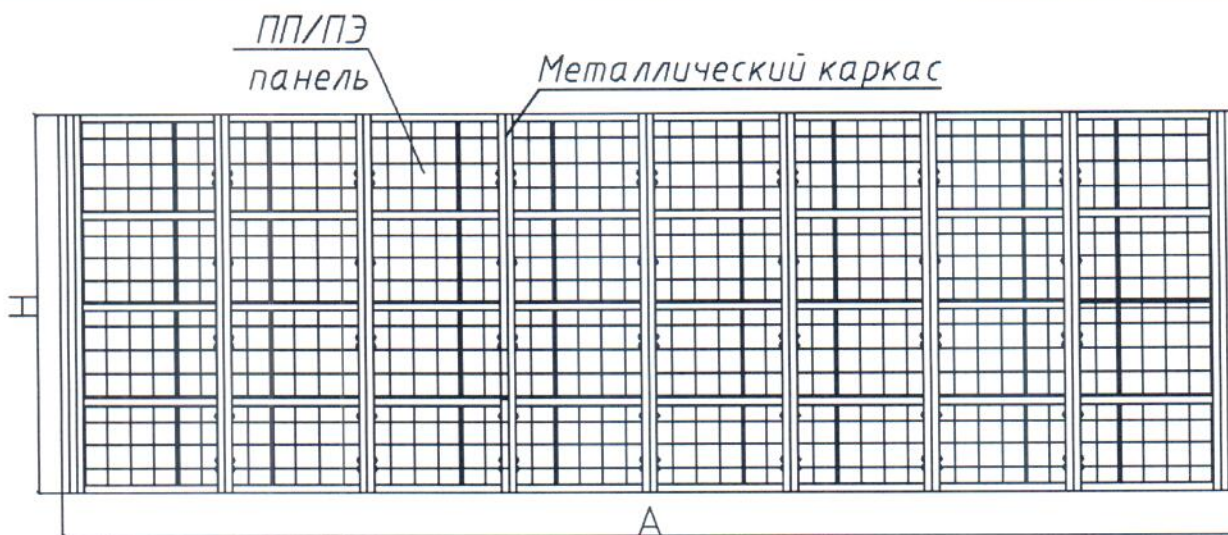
Общий вид резервуара прямоугольного исполнения сборно/разборного торговой марки «Таубер»
